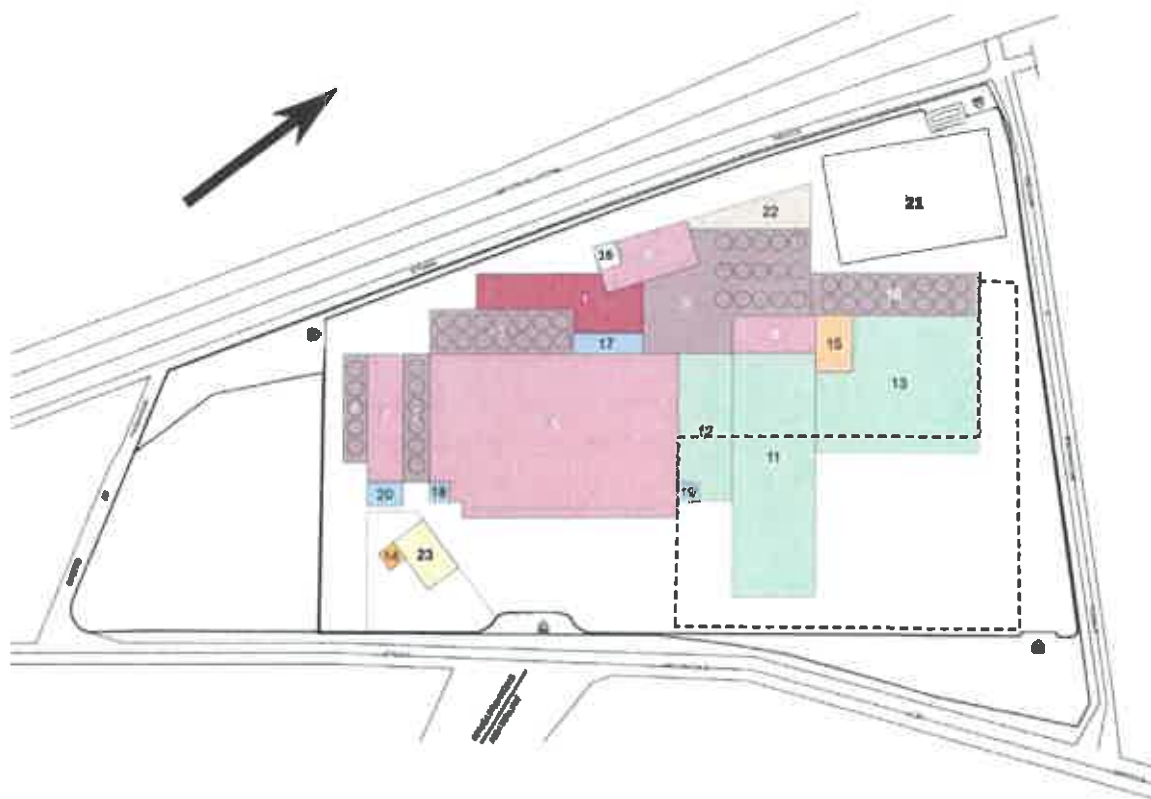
Planimetria dello stabilimento e individuazione delle aree di servizio
